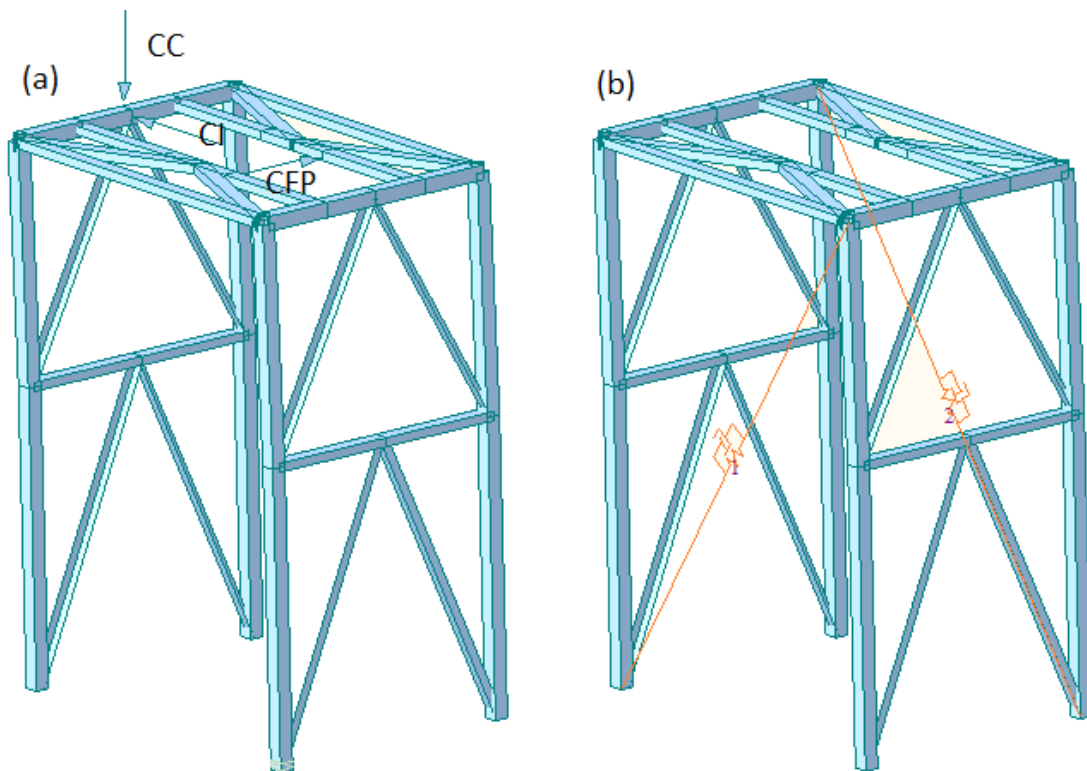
Modelo Estructura de Soporte Lateral (a) sólo perfiles y cargas, y (b) con cables trabajando a tracción.
